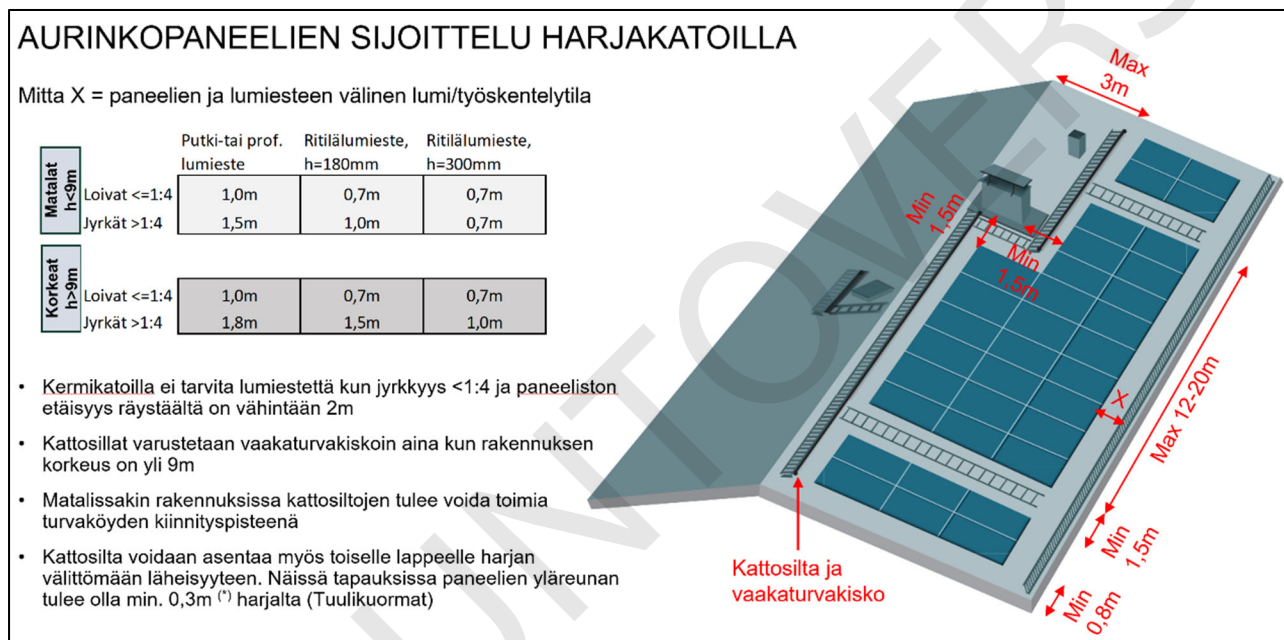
Minimi suojaetäisyydet ja soveltuvat alueet sijoitettaessa aurinkopaneeleja loiville katoille. Kuva Rami Mustonen.
